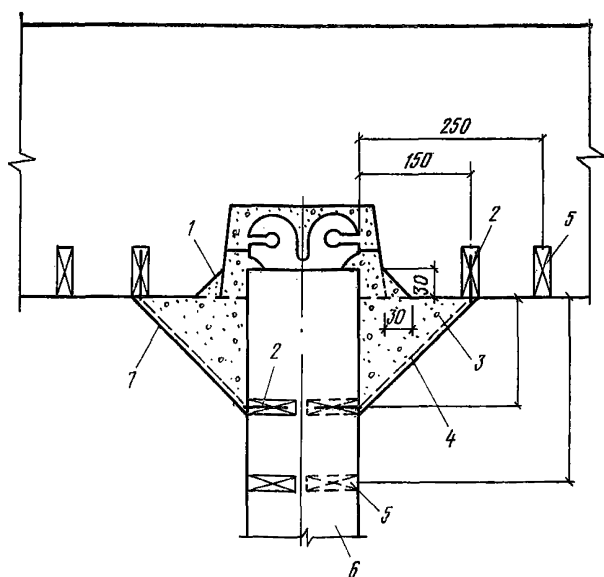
Утепление углов в местах заделки перегородки в наружную стеновую панель
